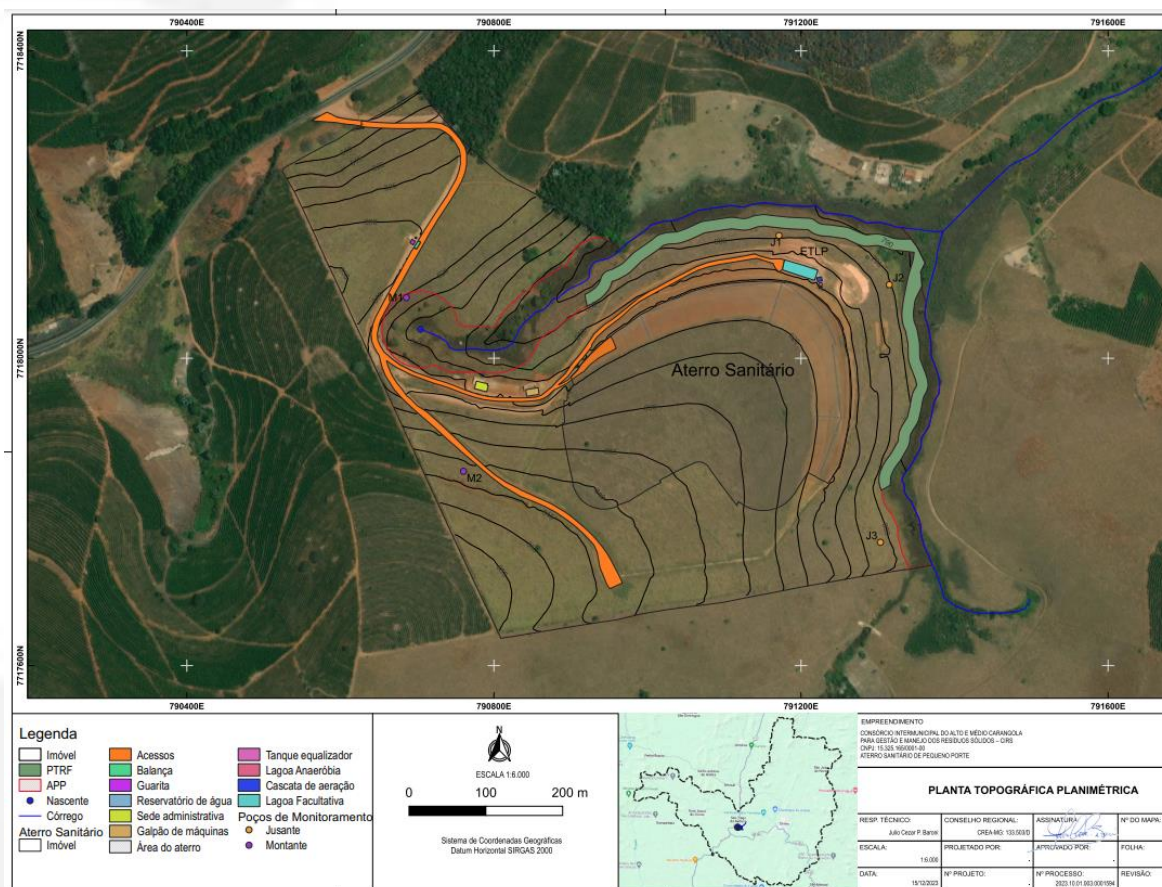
Planta topográfica com a delimitação e localização das estruturas que compõem o aterro sanitário.
